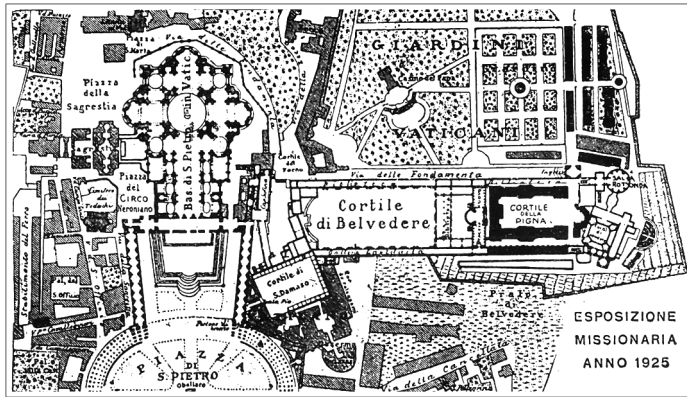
Planta general de las áreas vaticanas. Los signos negros indican las construcciones para la Exposición.
